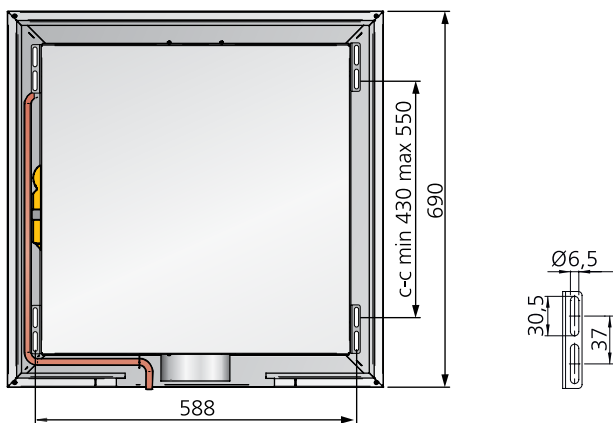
ADAPT Parasol EX 690, Draufsicht
